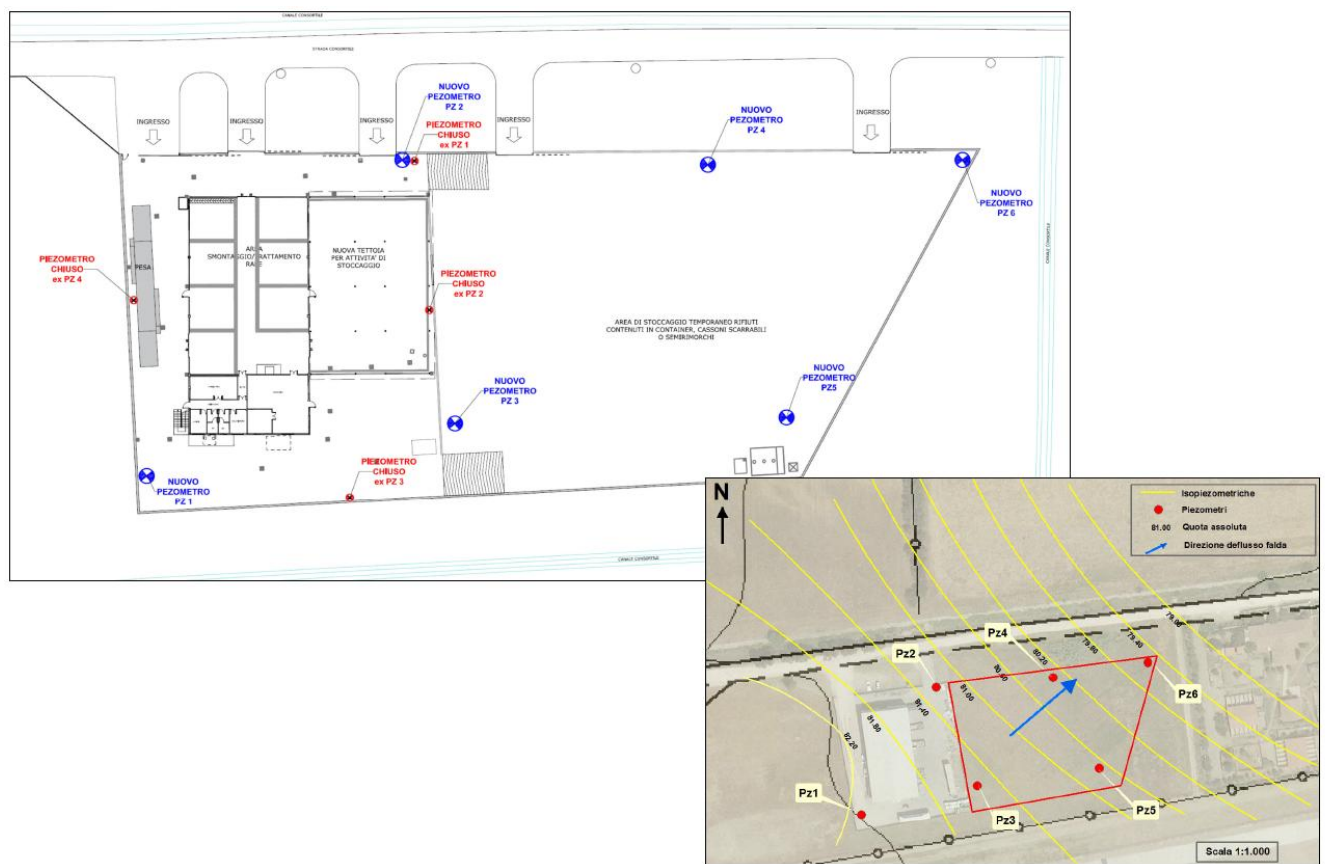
Planimetria rete piezometrica completa (vecchi e nuovi piezometri) e direzione del flusso di falda
